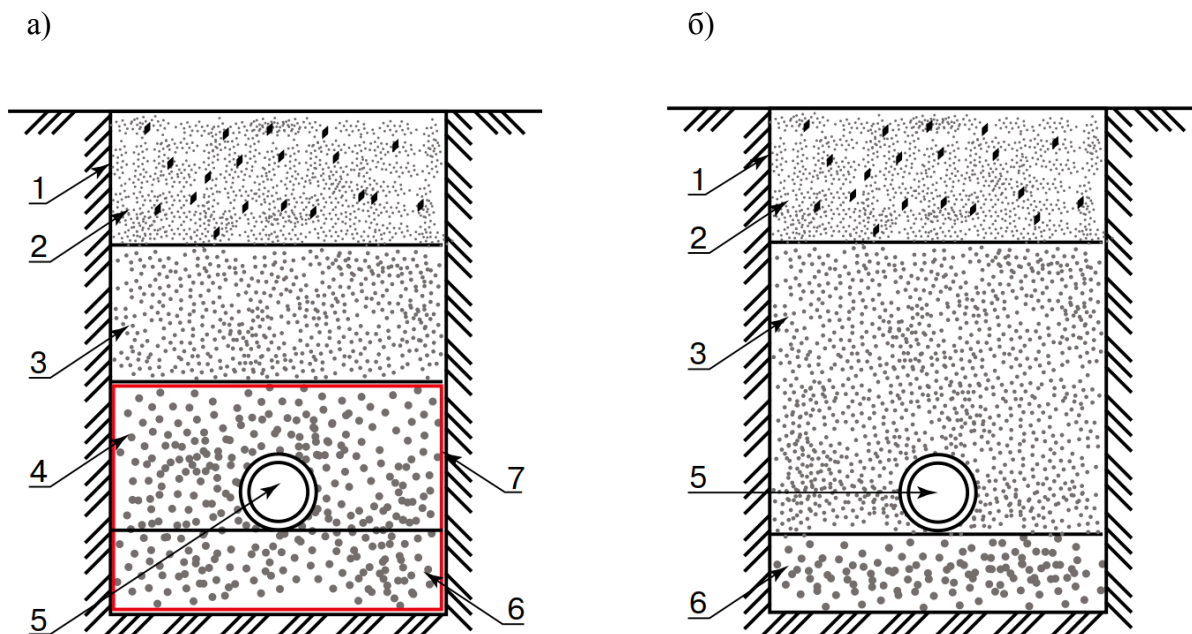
схемы укладки дренажных труб: а) – труба без геотекстиля, б) – труба с геотекстилем 1 – контур траншеи; 2 – местный грунт; 3 – обратная засыпка песком; 4 – обсыпка мелким щебнем; 5 – дренажная труба; 6 – основание из мелкого щебня; 7 – геотекстиль
